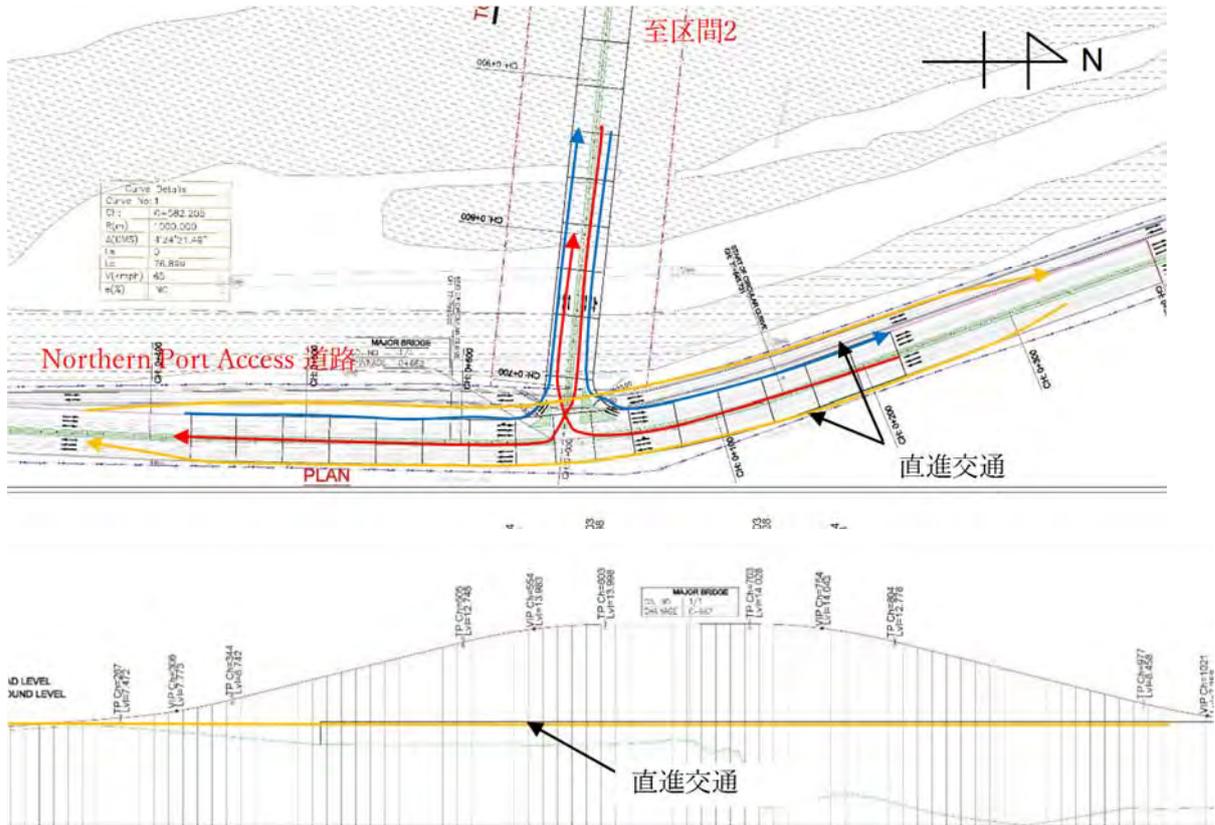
JCT-1 計画図(平面図・縦断面図)
